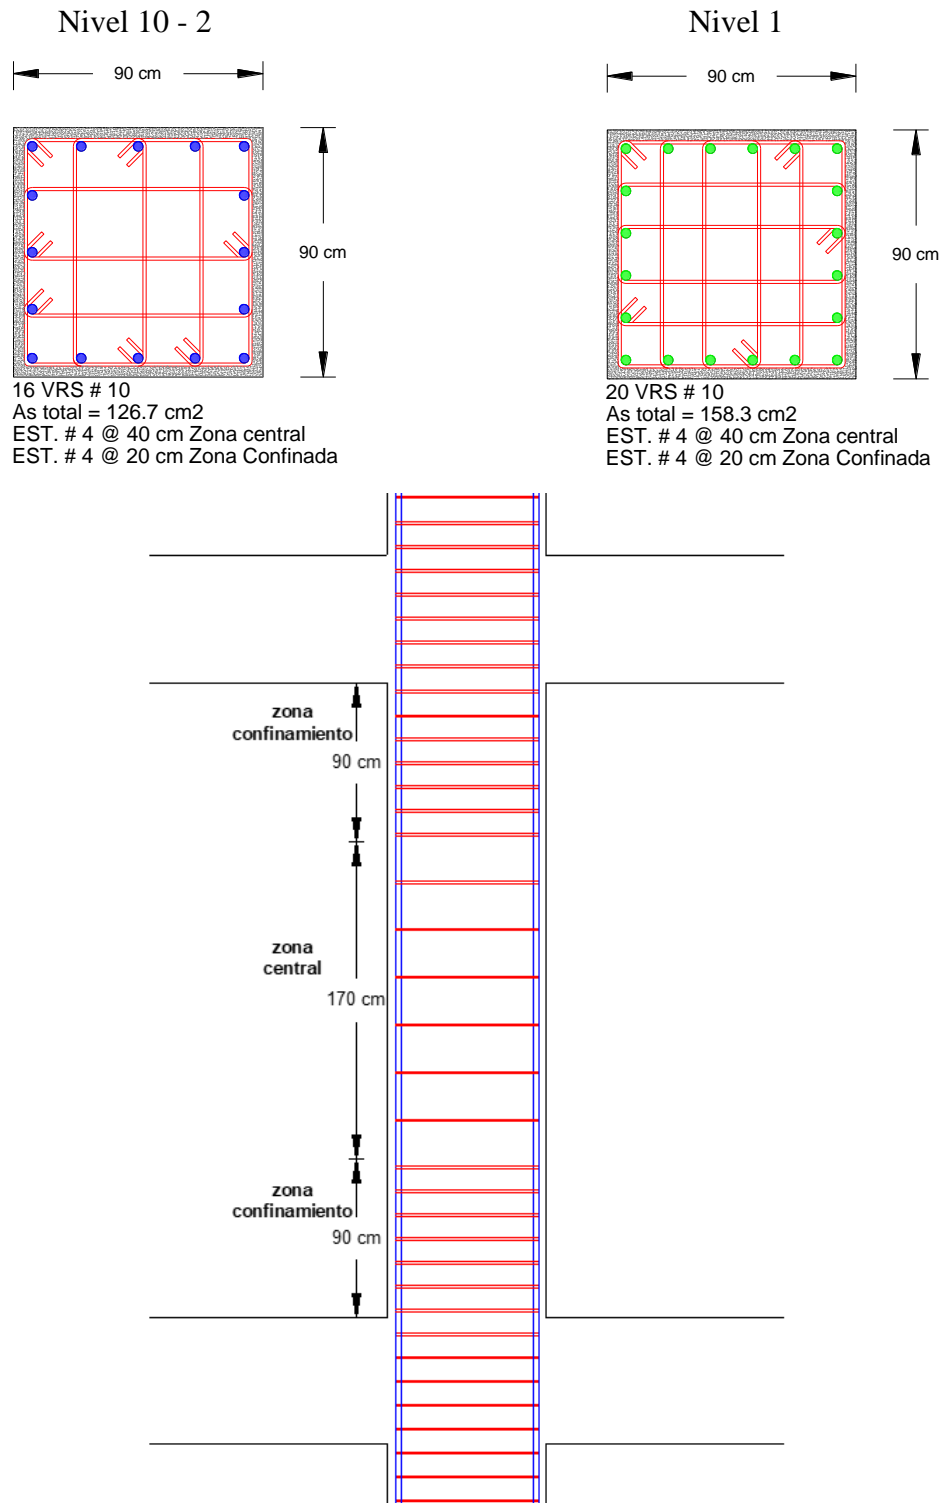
Detallado del refuerzo en columnas para el sistema de marcos
